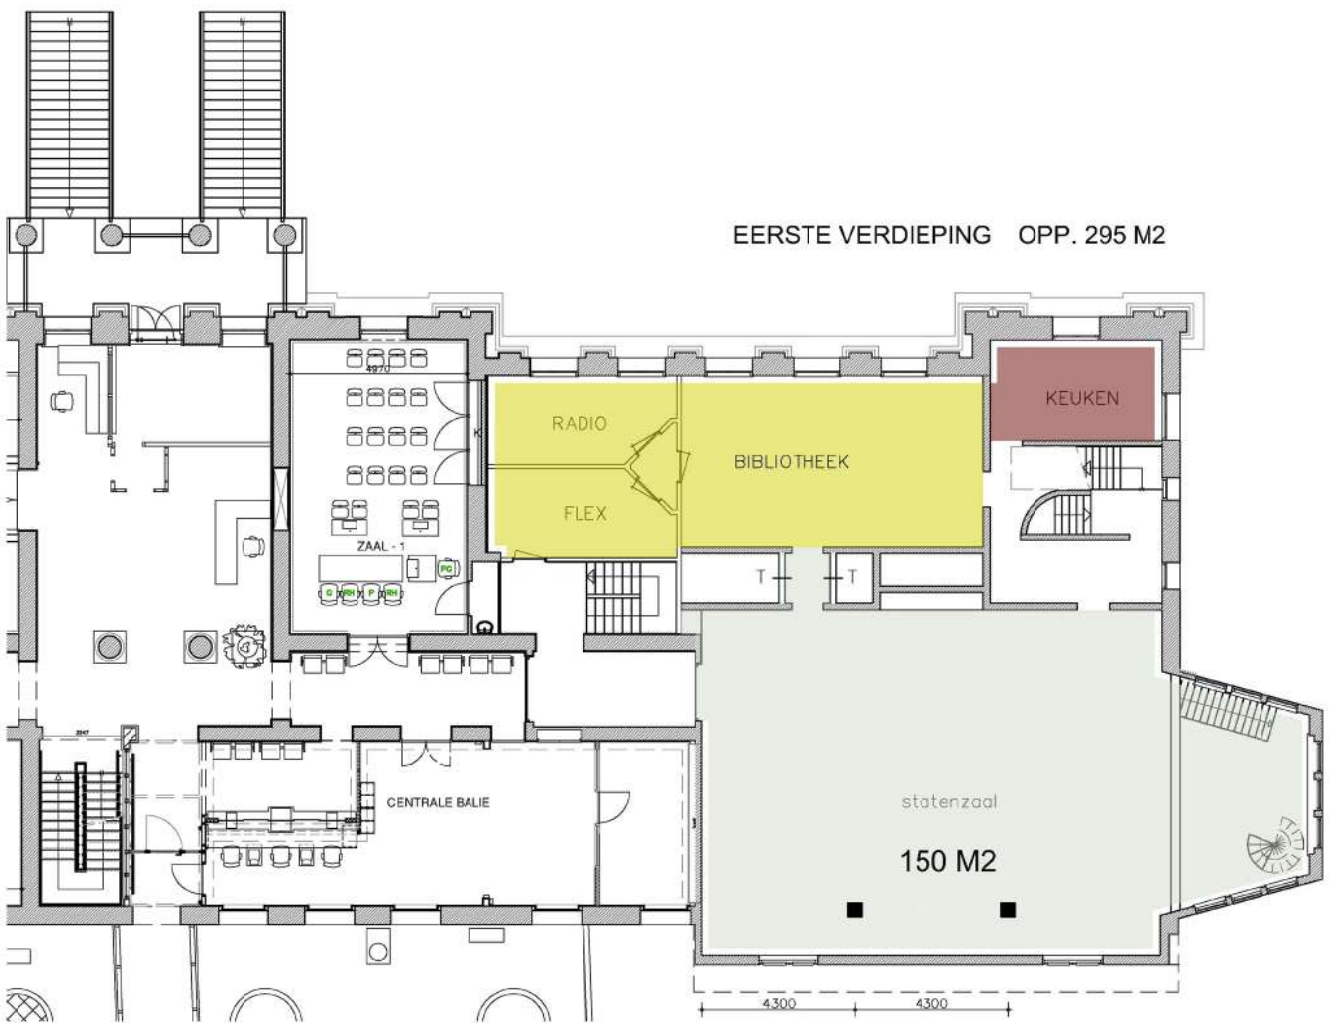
Bestaande Situatie Wilhelminaplein met onderzoek uitbreiding entree en benodigde ruimte
